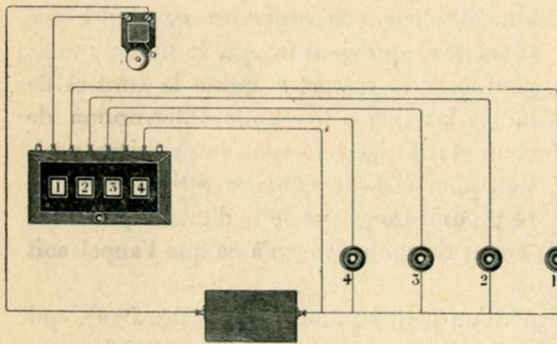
Installation d'une sonnerie avec boutons d'appel et tableau indicateur.
